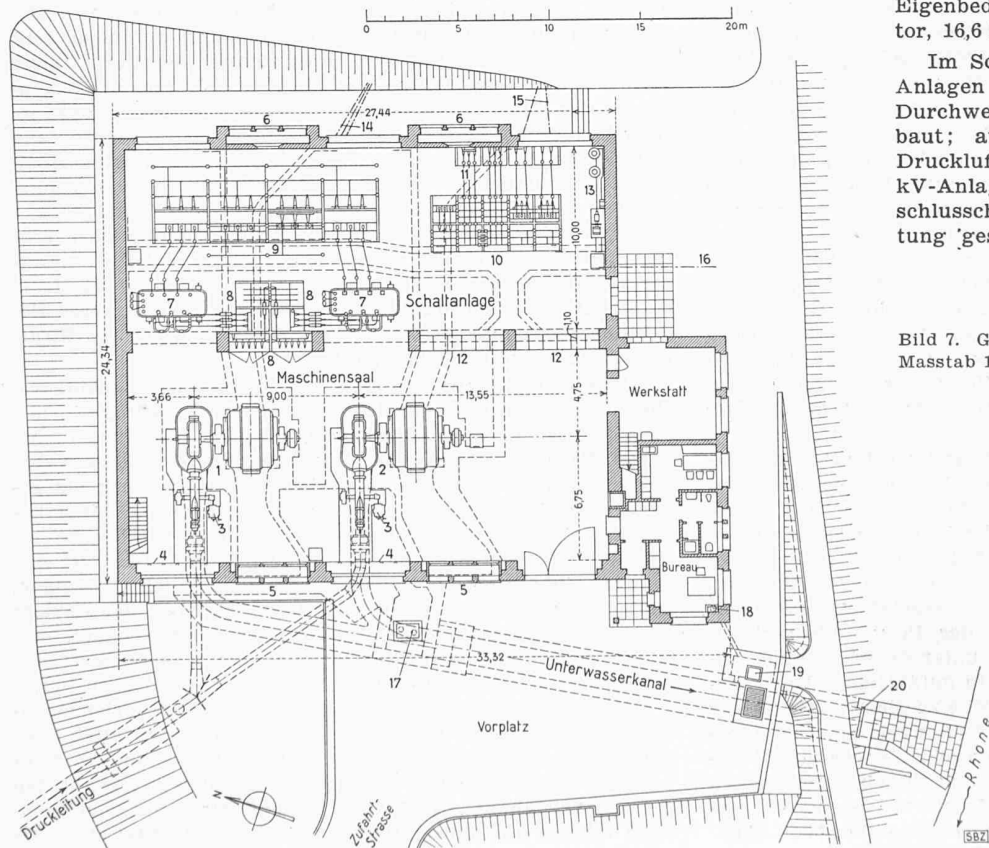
Grundriss des Maschinenhauses, Masstab 1:400
